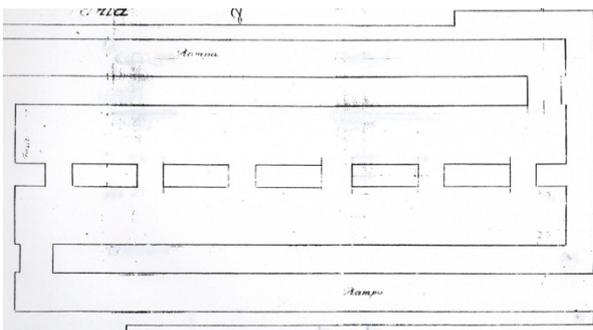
Planta tipo de refugio para centro escolar, formado por dos naves abovedadas y acceso mediante rampas. AHMV.
